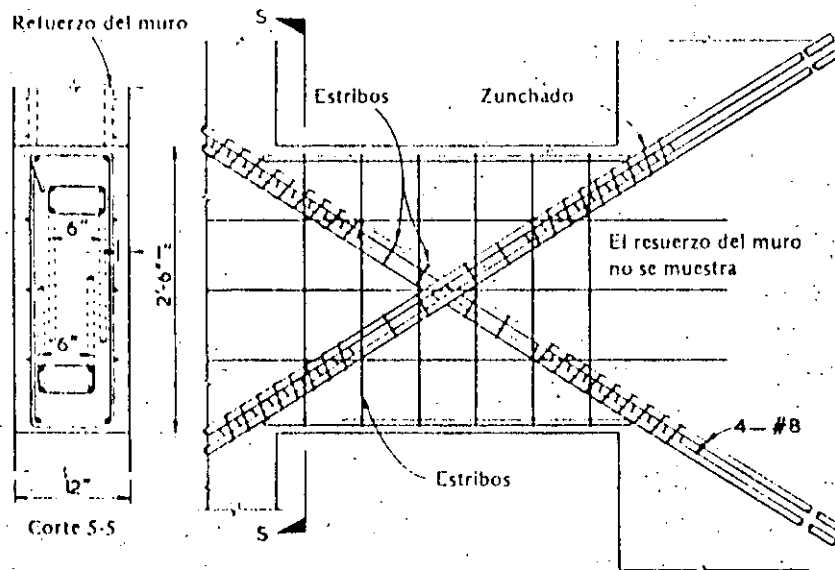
Refuerzo sugerido para una viga corta de acoplamiento (según Paulay^{3,34}).
